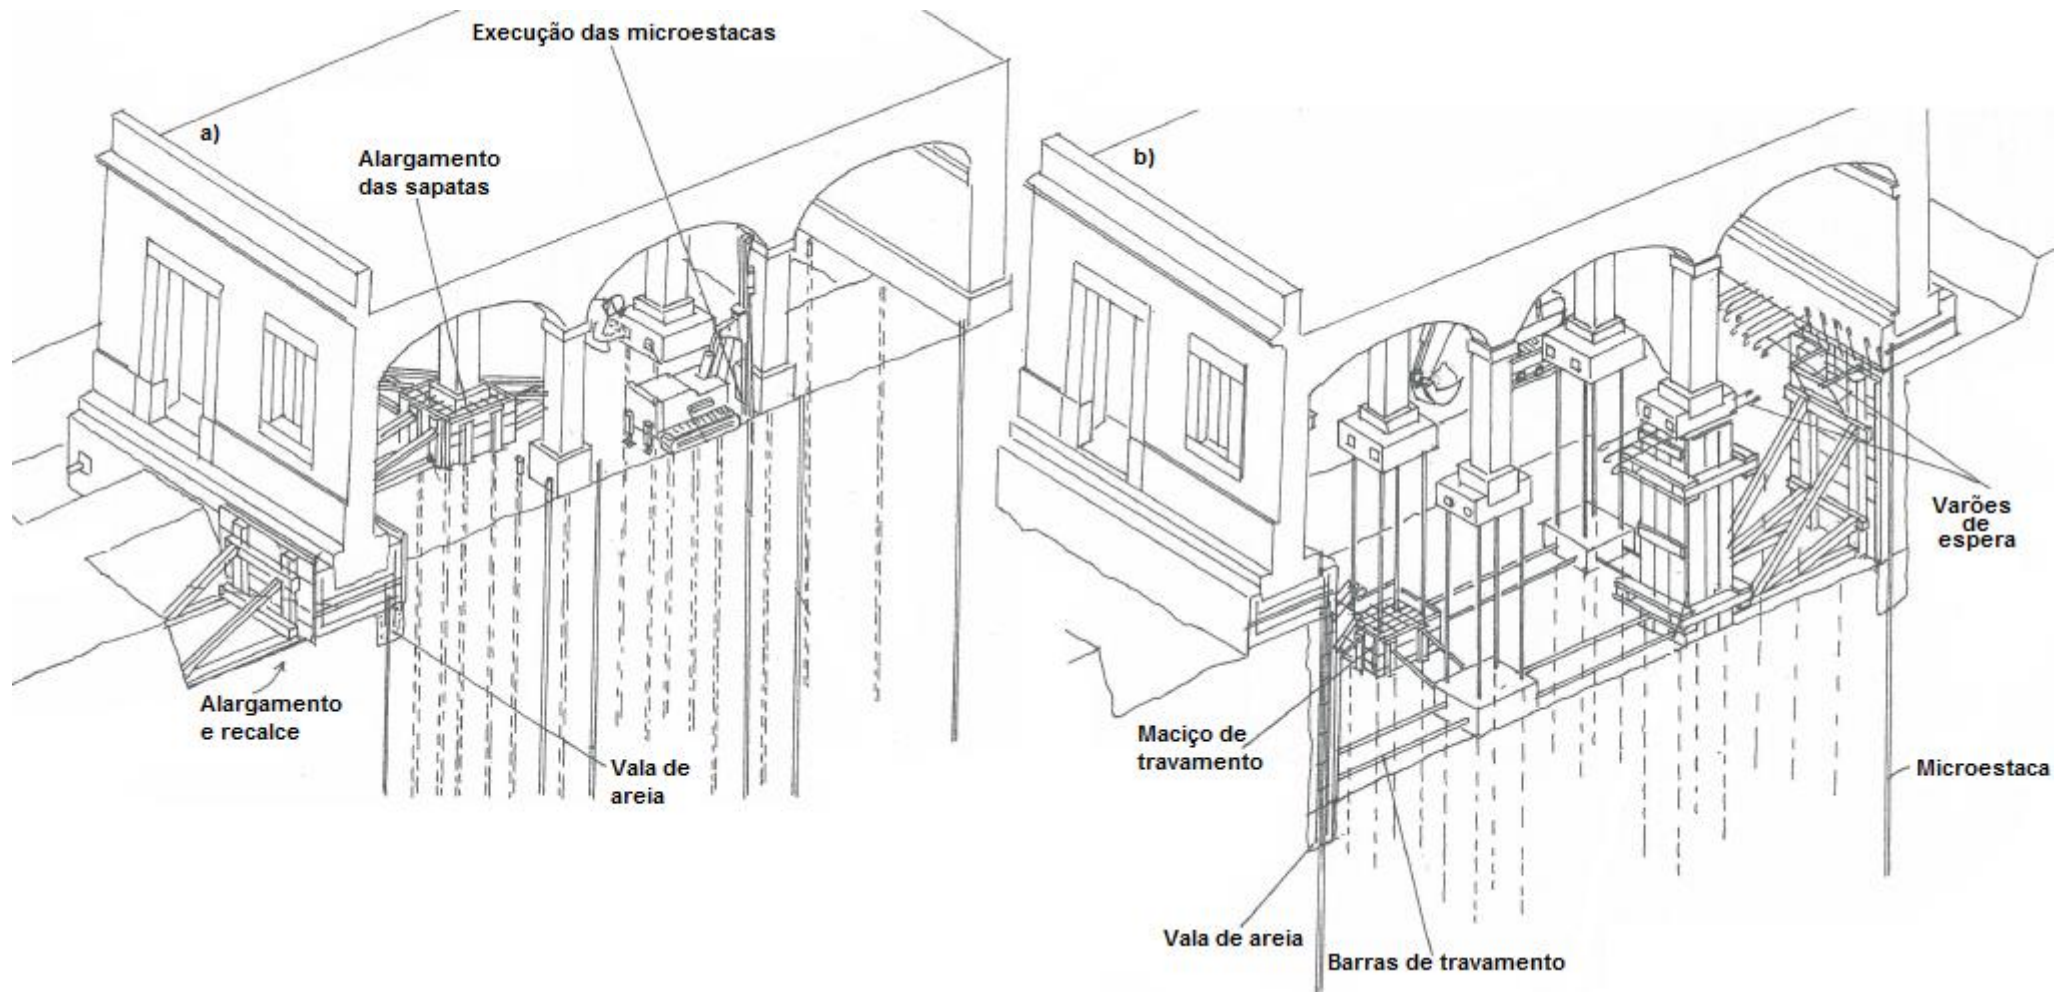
Construção da cave: a) reforço das fundações; b) escavação e execução dos painéis do primeiro nível [55]
